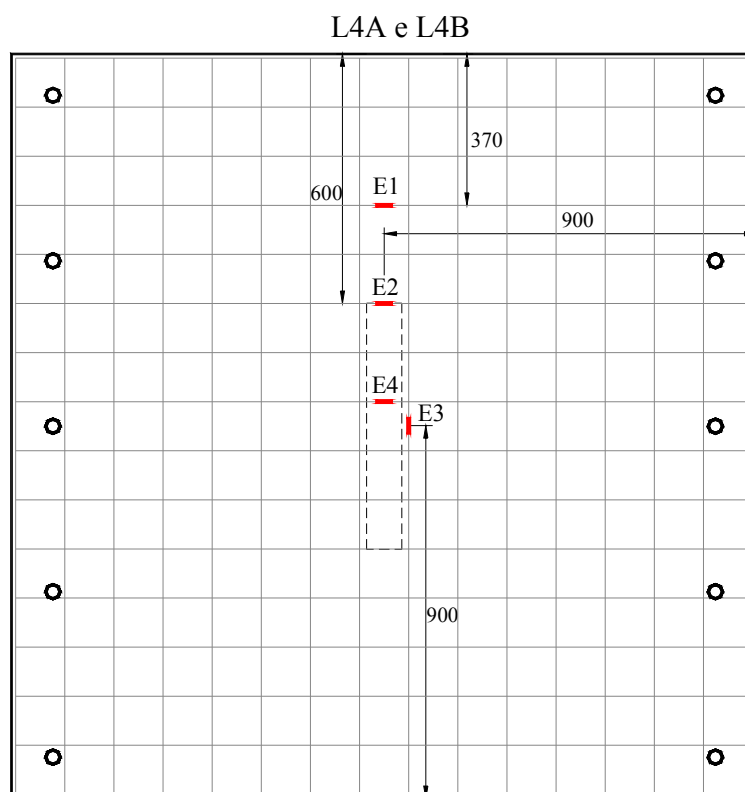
Instalação de extensômetros nas armaduras principal e secundária das lajes L4A e L4B
